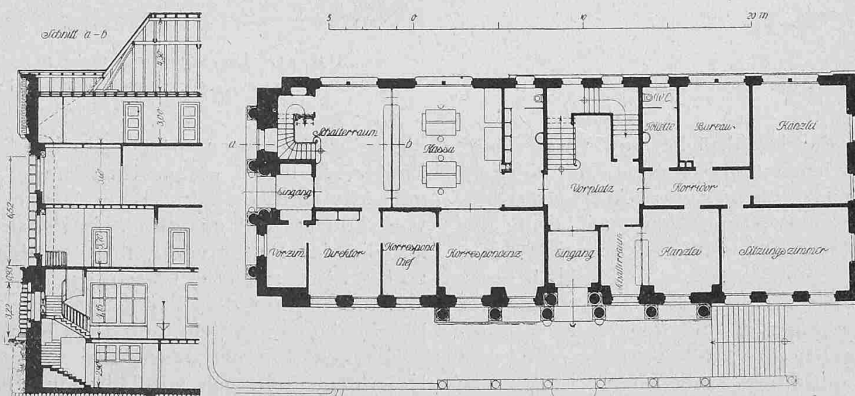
Schnitt a-b und Abb. 3 Erdgeschoss-Grundriss. — Masstab 1:400.
